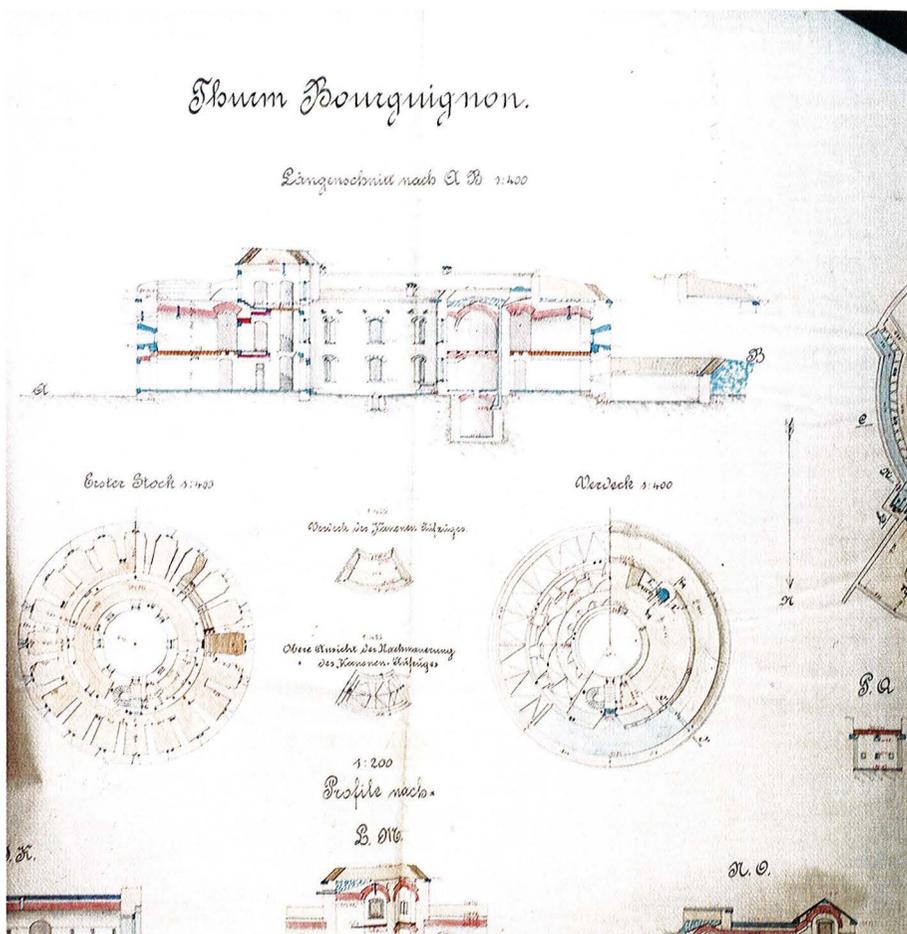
Forte Bourguignon, tipo circolare (disegno 53).
